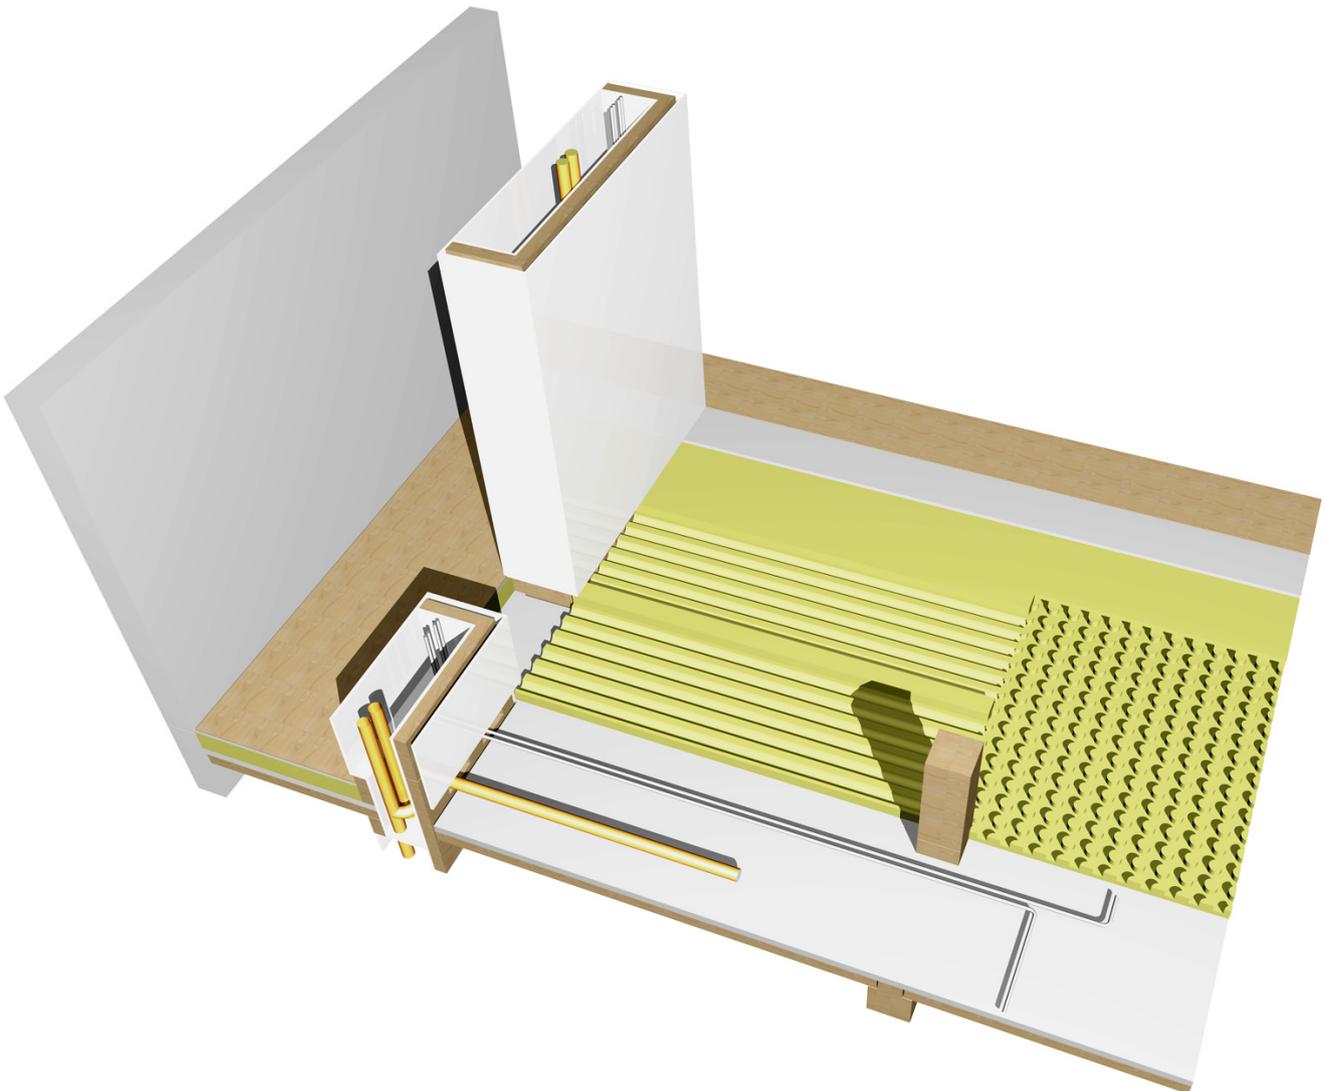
Detailperspektive des Installationsbodens mit Darstellung des Bodenaufbaus in Schichten
